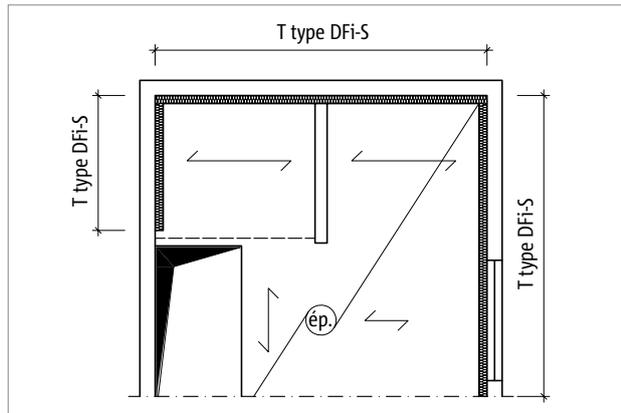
Schöck Rutherma® T type DFi-S : utilisation entre la dalle et la façade
